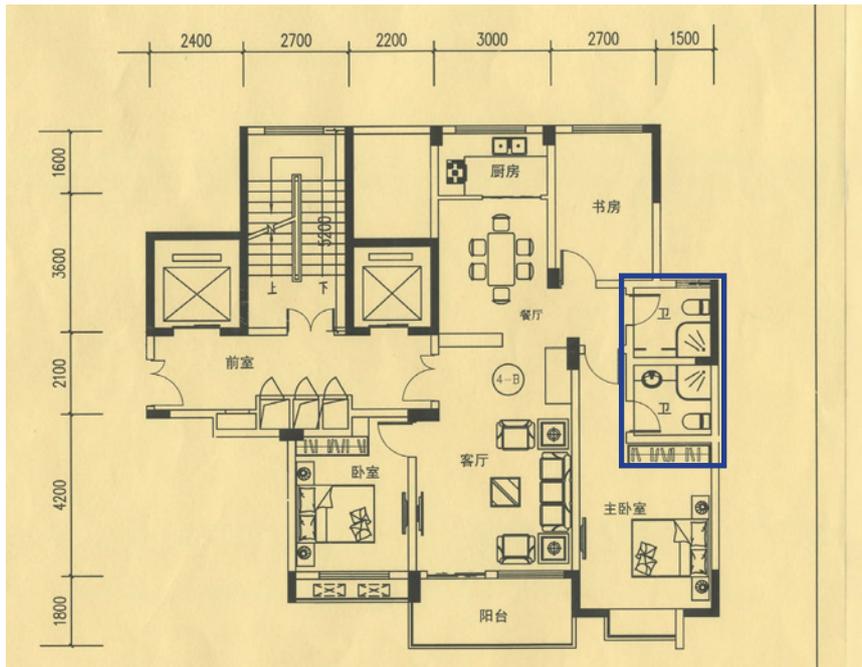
Bsp.2: Grundriss eines 2-Spanners
